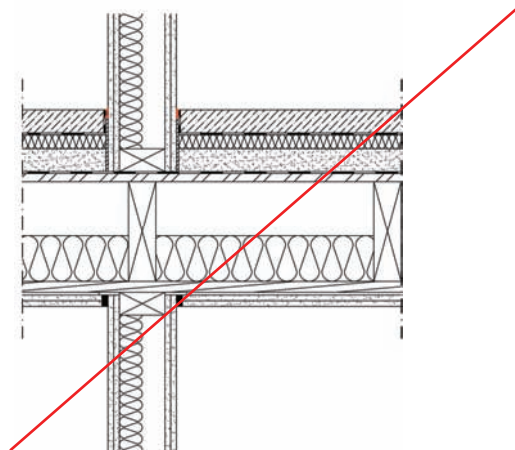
Koppelung durch Spachtelmasse aufgrund zu früh abgeschnittener Estrichdämmstreifen
